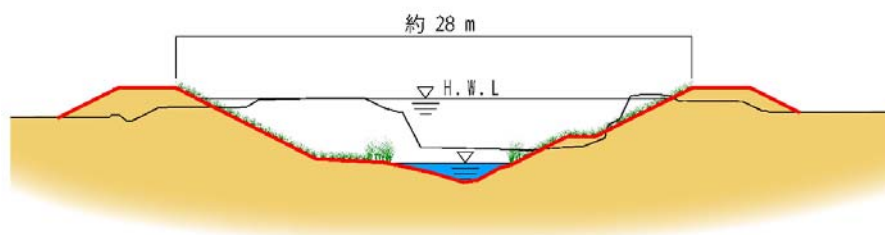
中池江川整備計画平面図（工事施行の場所）及び代表断面図
